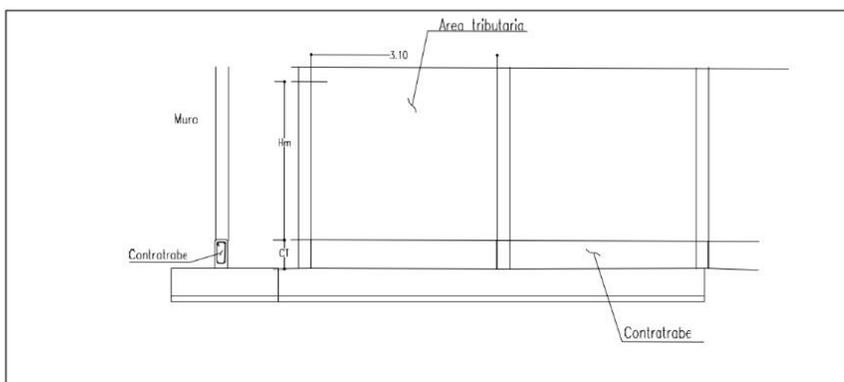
Vista Frontal de la Fracción Tributaria para Análisis del Muro
